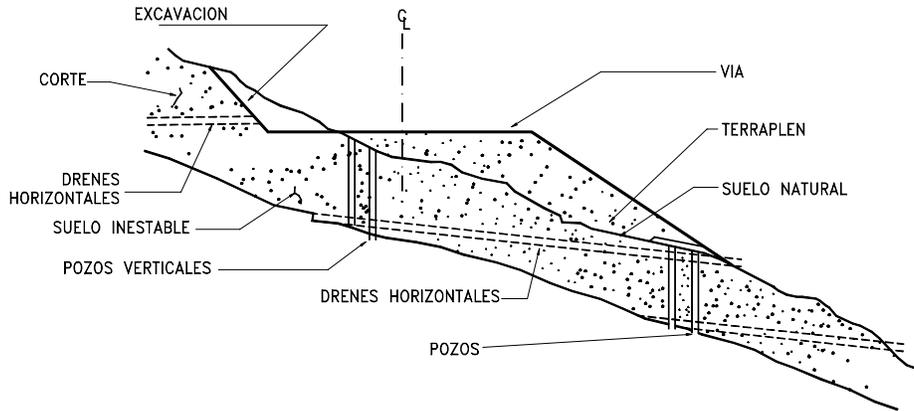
Combinación de pozos verticales y subdrenes horizontales.
